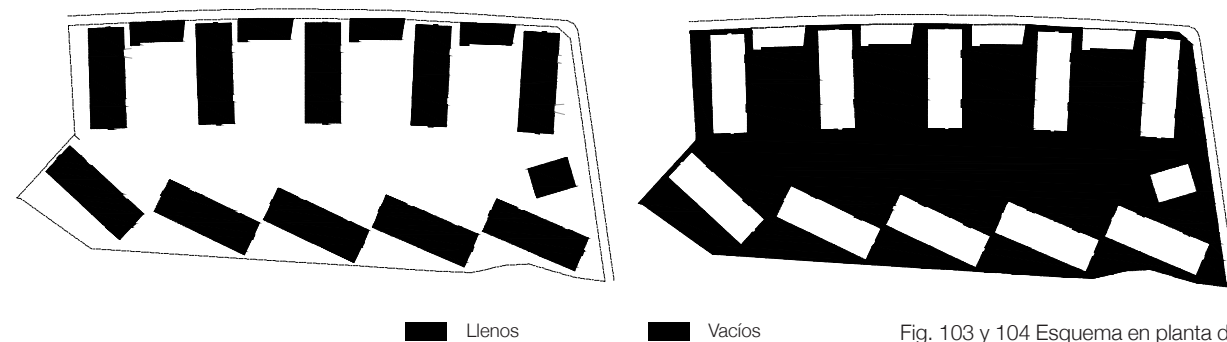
y 104 Esquema en planta de vacíos y llenos E. 1:2000
